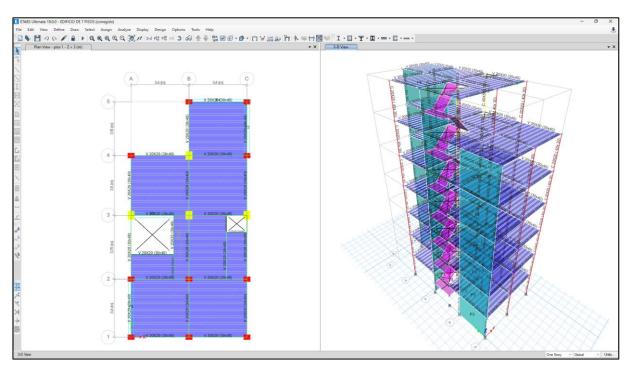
Modelamiento de la estructura reestructurada en Etabs
